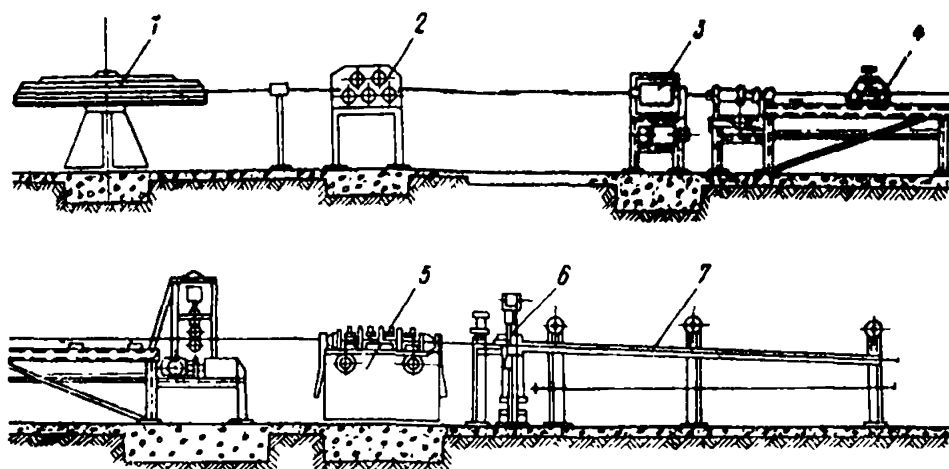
Автомат для заготовки высокопрочной проволоки с высаженными концевыми и промежуточными головками (НИИЖБ)
